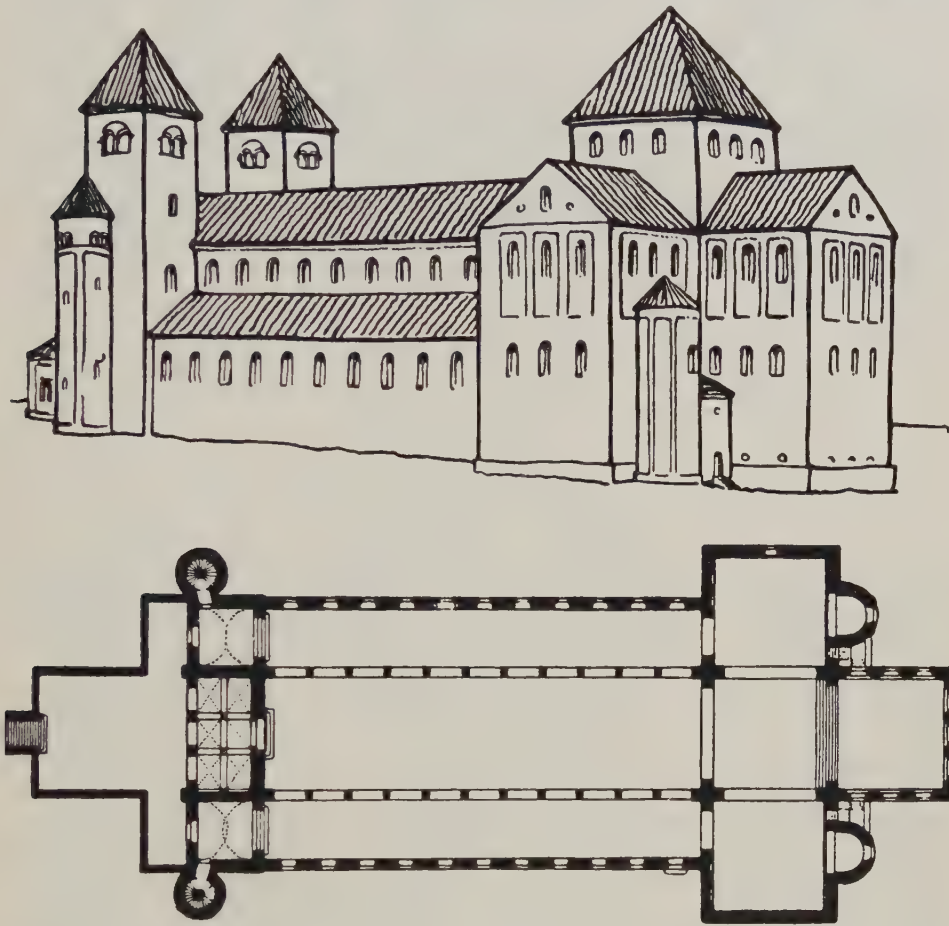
Limburg a. d. H., Stiftskirche, Rekonstruktion und Grundriß. Nach Frankl
